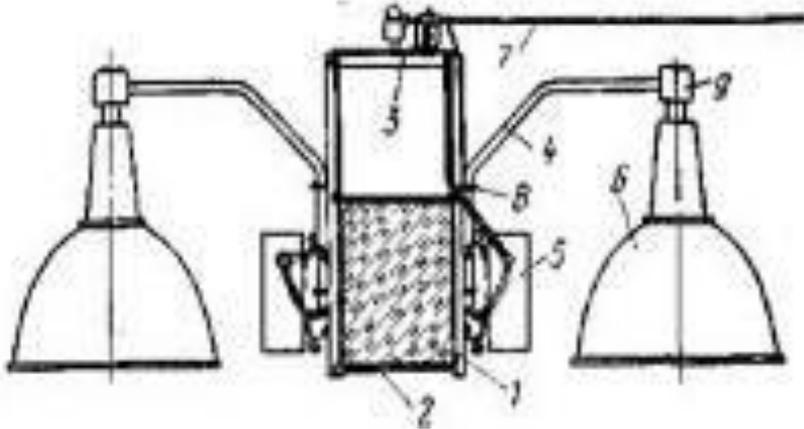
Крепление светильников и осветительной сети, выполненной проводами на изоляторах, к нижнему поясу железобетонной фермы: 1-стойка, 2-шпилька, 3-траверса, 4-кронштейн, 5-ПРА, 6-светильник, 7-провода, 8-хомутик, 9-коробка
